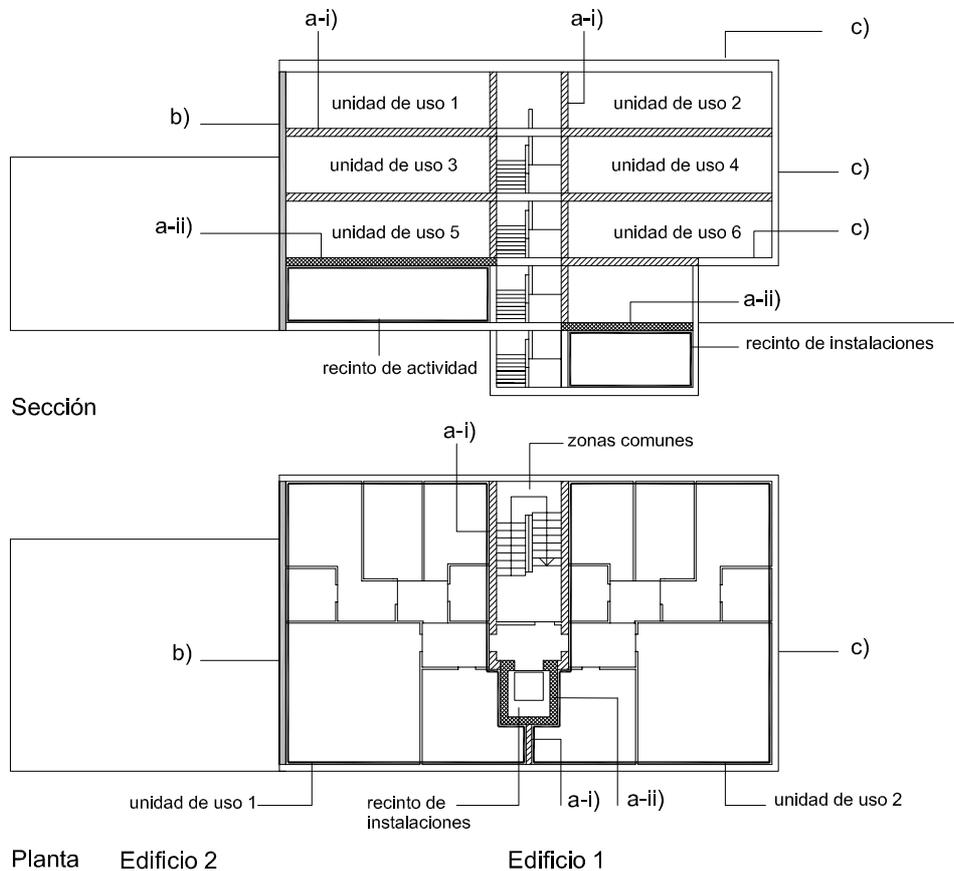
Elección de la solución. Esquemas en planta y sección
